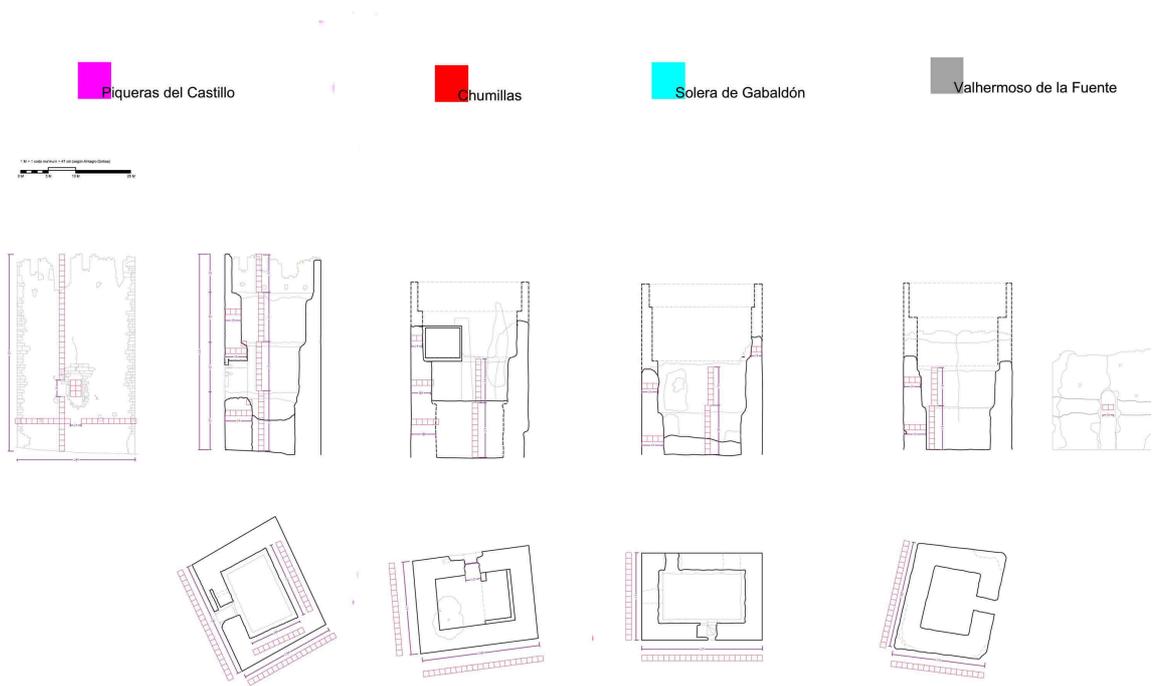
Estudio modulación de cuatro torres. Planta – Alzado. RUIZ – CRISTINI 2012
